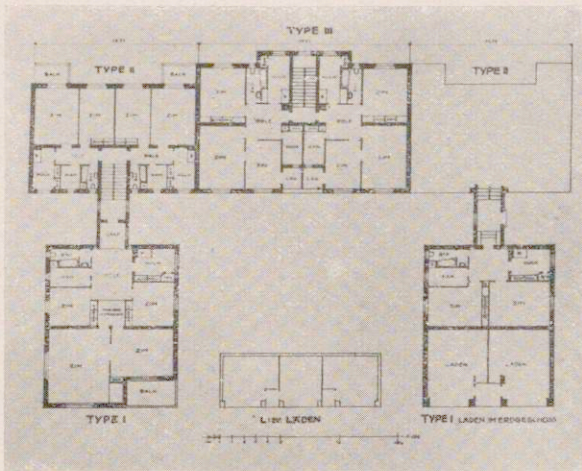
Mietshausgrundrisse. S. Abb. 7
